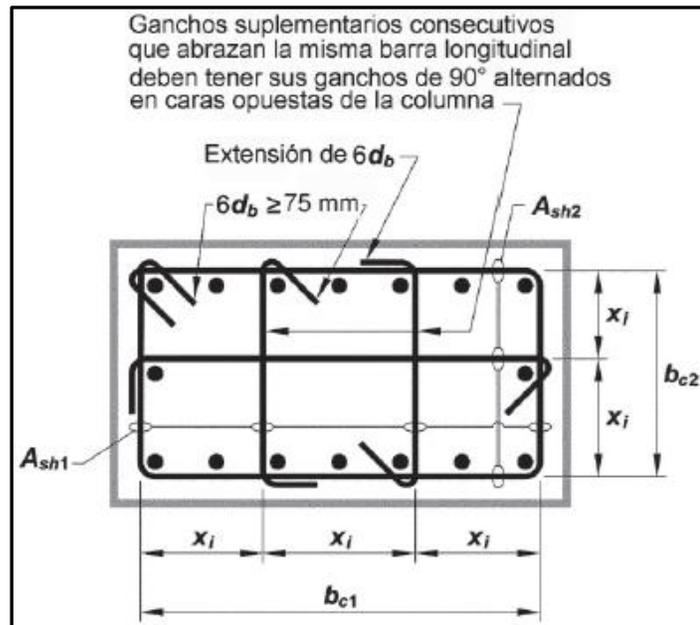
Ejemplo de refuerzo transversal en columnas. Fuente: Código ACI 318-14
